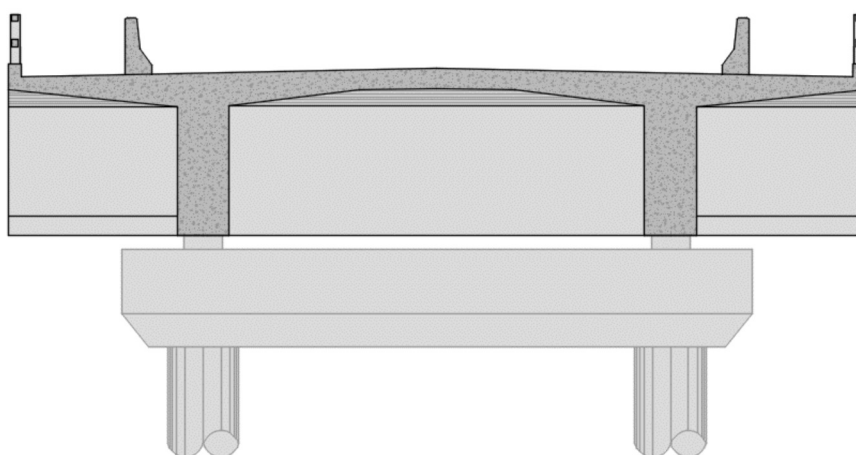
Seção transversal típica de duas vigas de concreto moldadas in-loco.
